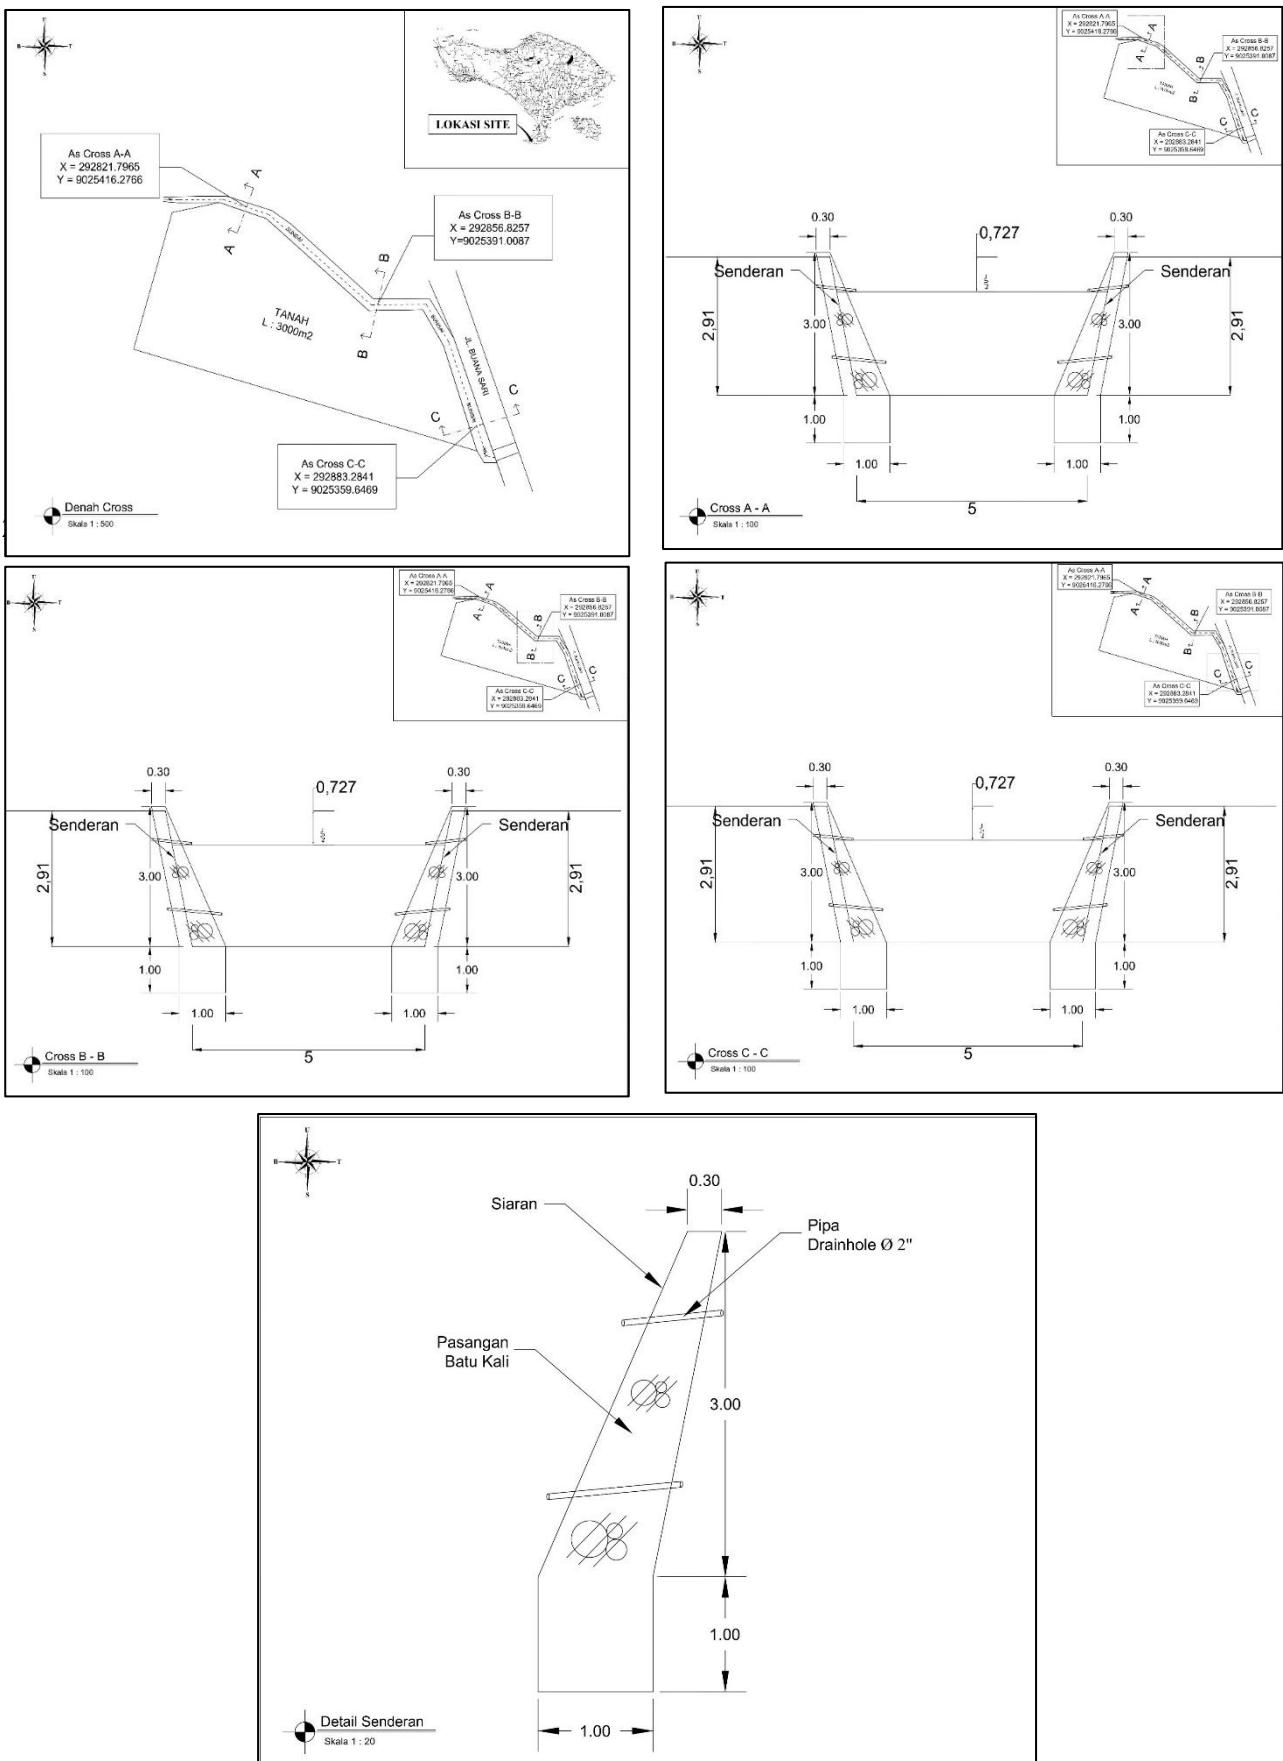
Desain Cross Section Saluran Drainase (Penulis, 2023)
